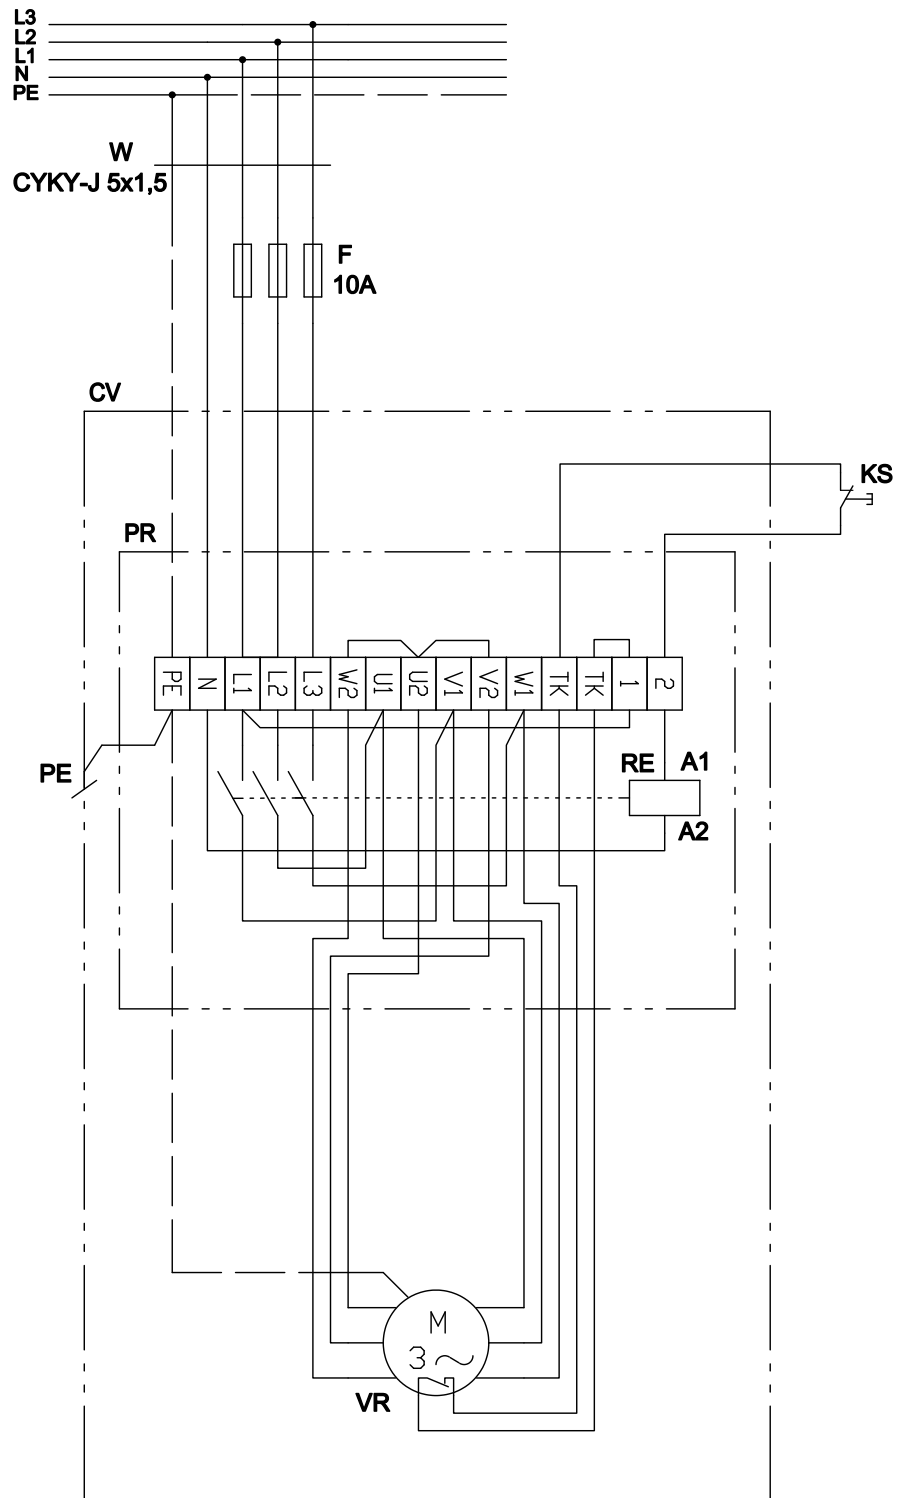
Schéma pro vratovou clonu se třífázovým motorem ventilátoru, zapojení do trojúhelníku
